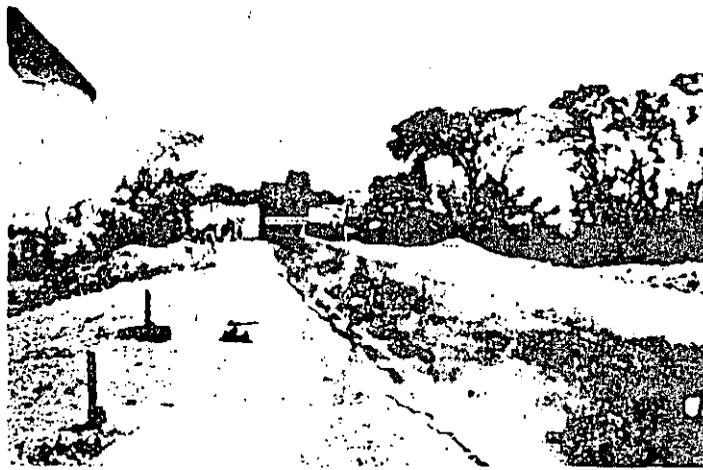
Crucero de las calles Tamaulipas e Hidalgo. Visto desde la calle Tamaulipas a la izquierda a San Roberto, a la derecha a Monterrey, atrás a México.
